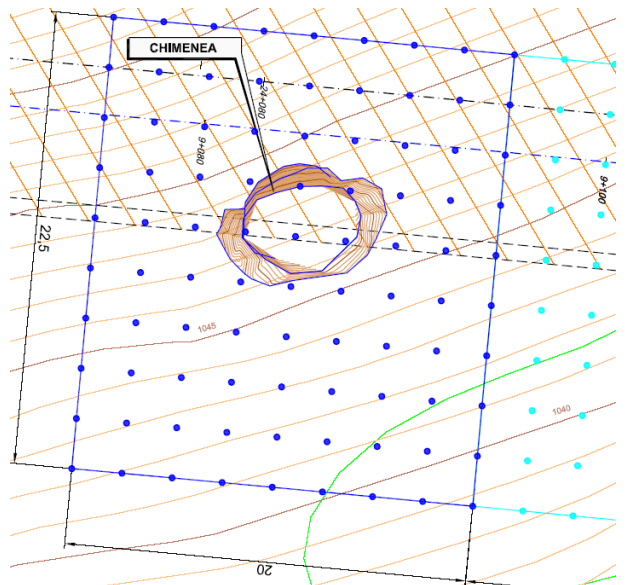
Planta de la chimenea en el p.k 9+084.
